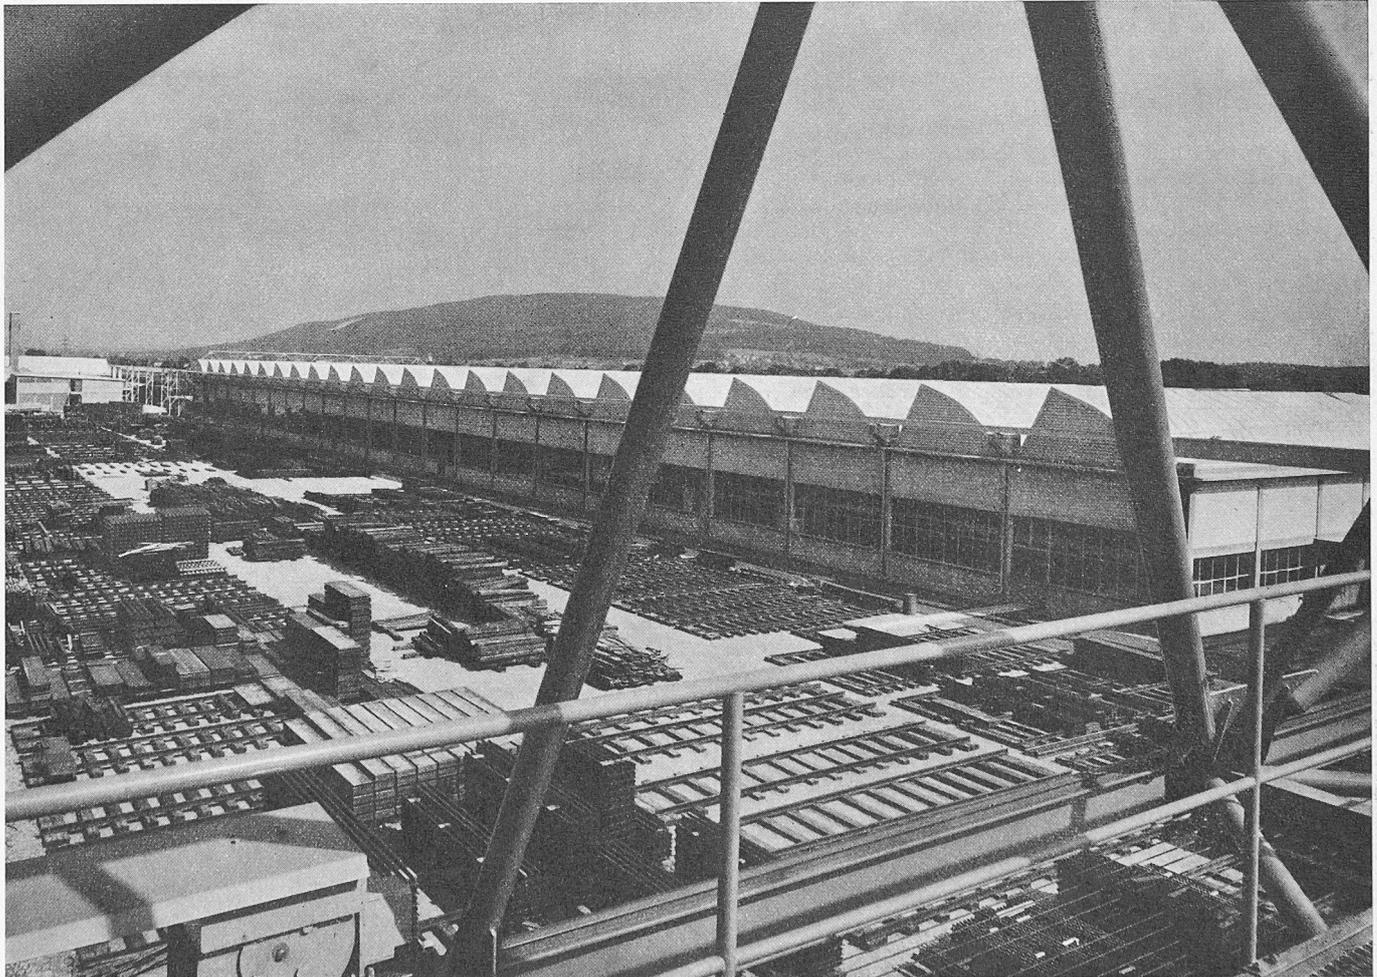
Nordfassade der Weichenbauhalle (Blick vom Laufkran)
